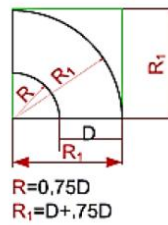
مسقط لشبكة مجرى هواء دائري المقطع
